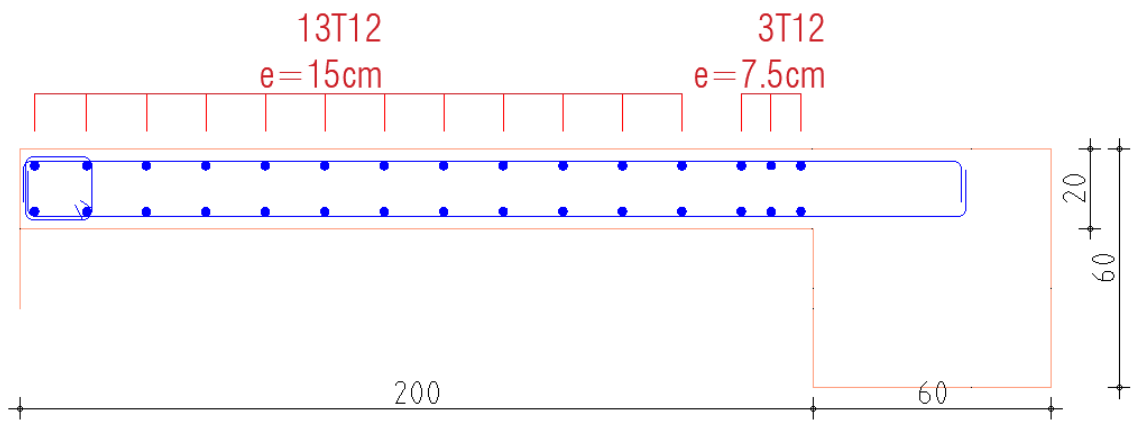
Ferrailage du voile Vx3 Zone 1
